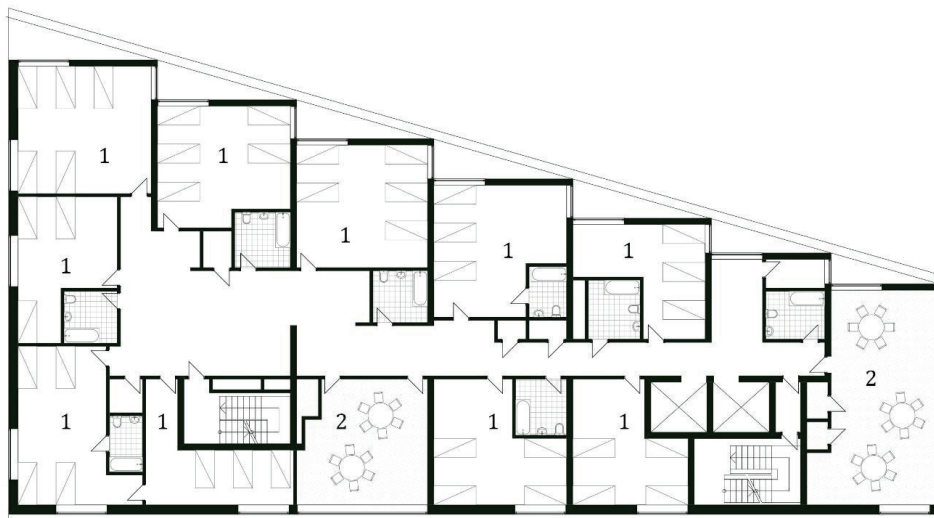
Imobil de locuințe de urgență în Washington: plan etaj curent cu dormitoare comune cu grupurile sanitare aferente (1) și spații comune (2)/ Emergency housing building in Washington: current floor plan with shared bedrooms with assigned bathrooms (1) and communal spaces (2).
